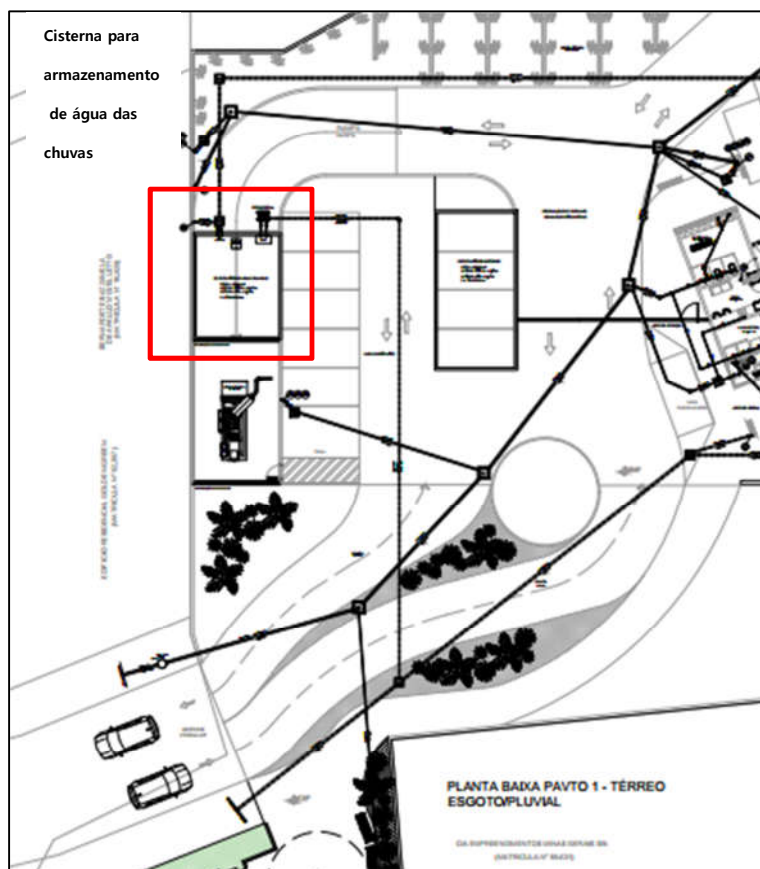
Cisterna de Água da Chuva – Planta Baixa
